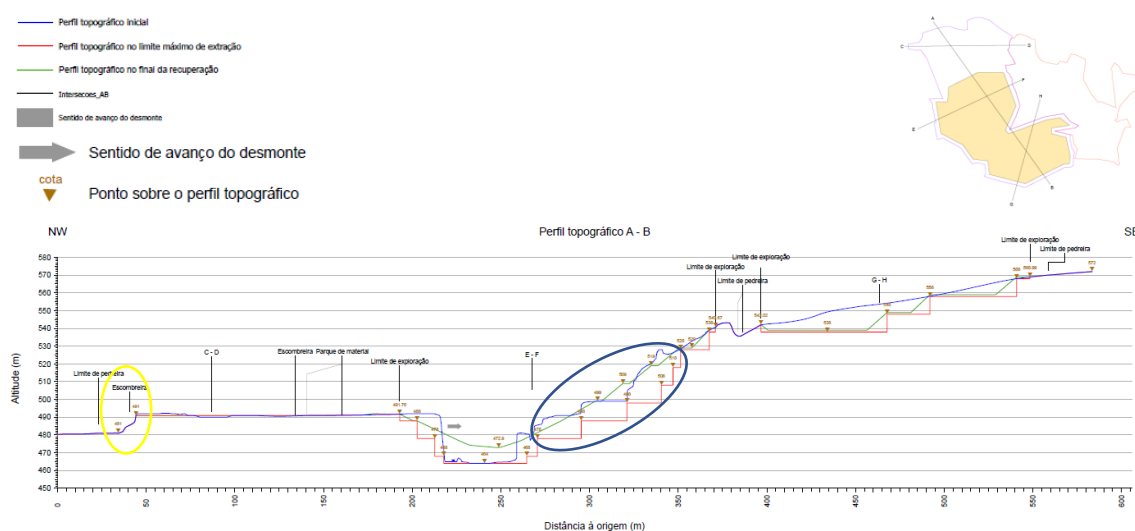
Perfil topográfico [A-B] do Plano de Lavra.
